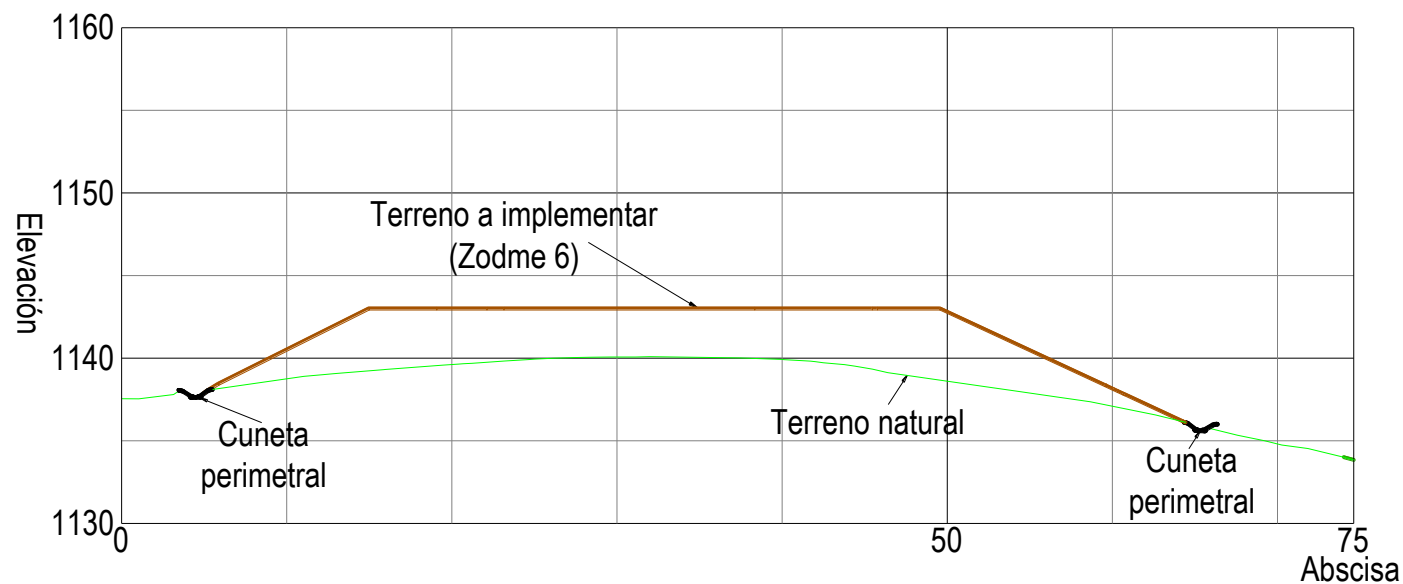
Sección B-B depósito 6. (Unidades en metros) – Para detalle de la cuneta perimetral ver Figura 3-37
